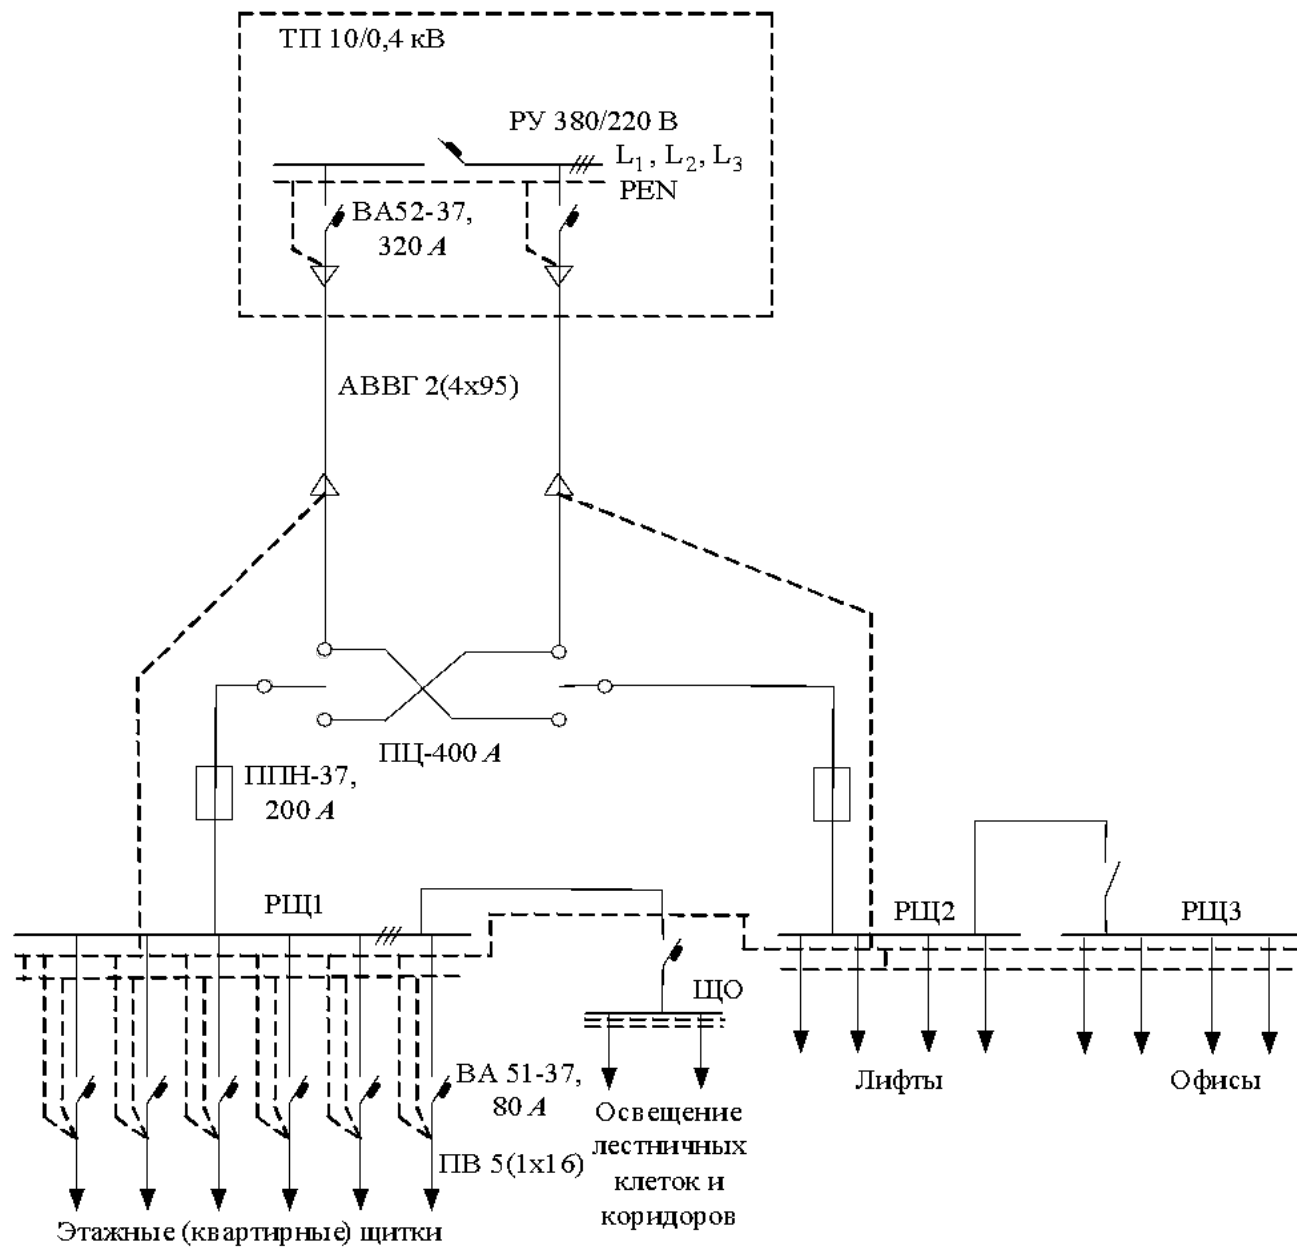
Схема электроснабжения многоэтажного жилого дома
